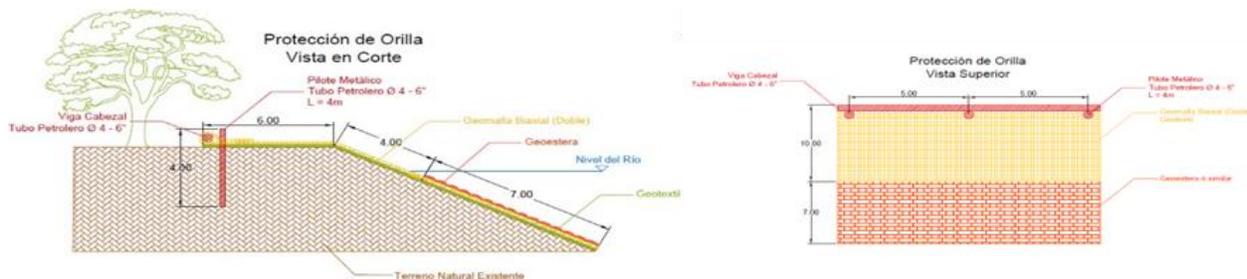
Fuente: planos formulación del proyecto, Viga cabezal y pilote de 6” para fijación de orillas
